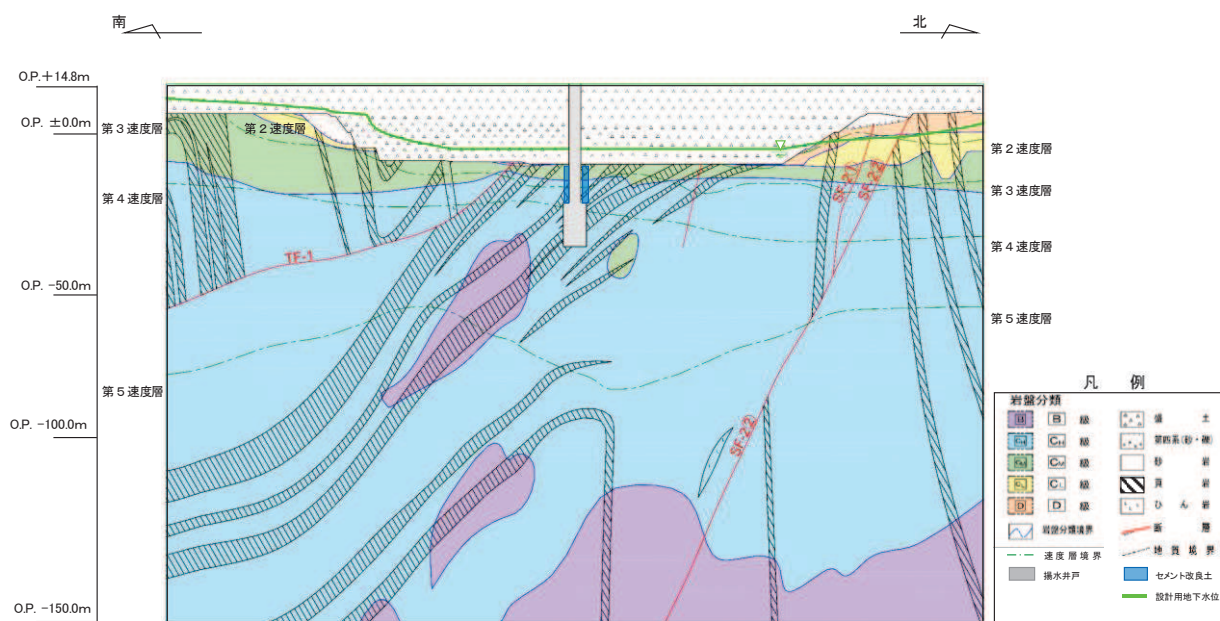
(2) No.2 揚水井戸 評価対象断面図 (B' -B 断面)
